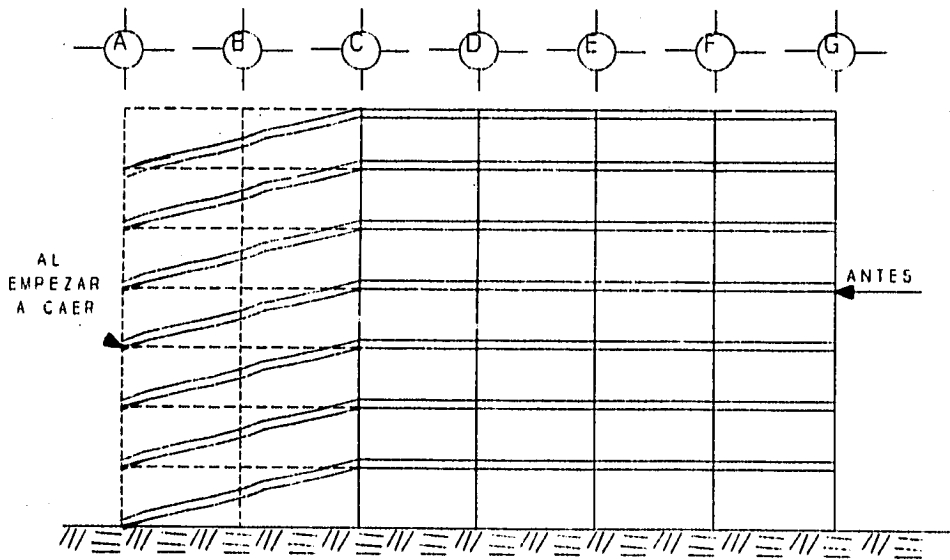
Para lograr el efecto mostrado se requiere tronar los ejes de columnas en el orden A,B,C,D,E,F,G. (también las columnas de planta baja)
